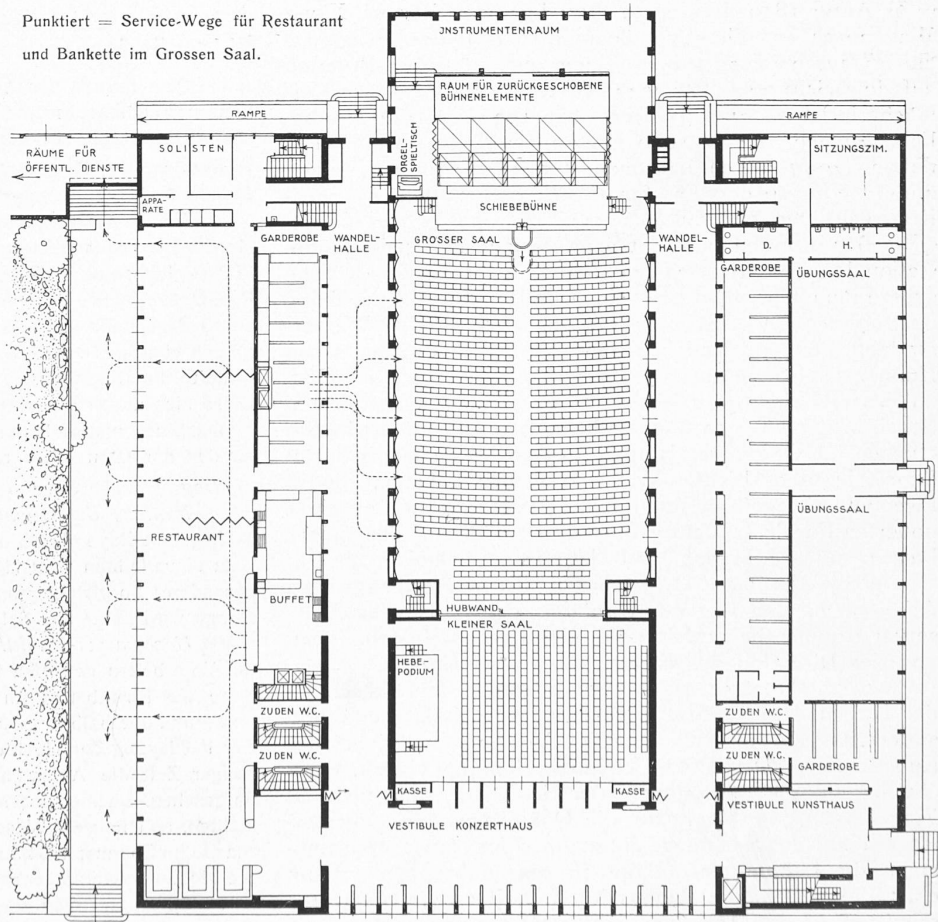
Erdgeschoss-Grundriss. — Abb. 7 (oben). Längs- und Querschnitt. — Alles 1 : 500.
